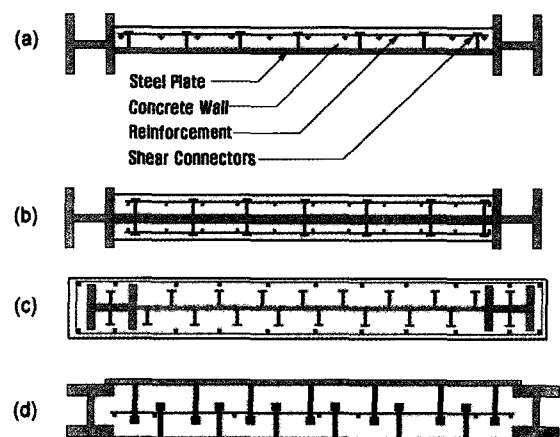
복합철골전단벽(Hybrid Steel Plate Shear Wall)
